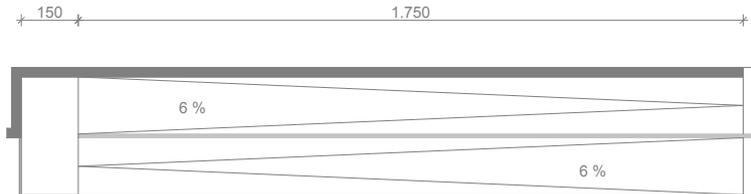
Grundriss der Rampe, welche direkt hinter dem Cafehaus gebaut wird M 1:200
